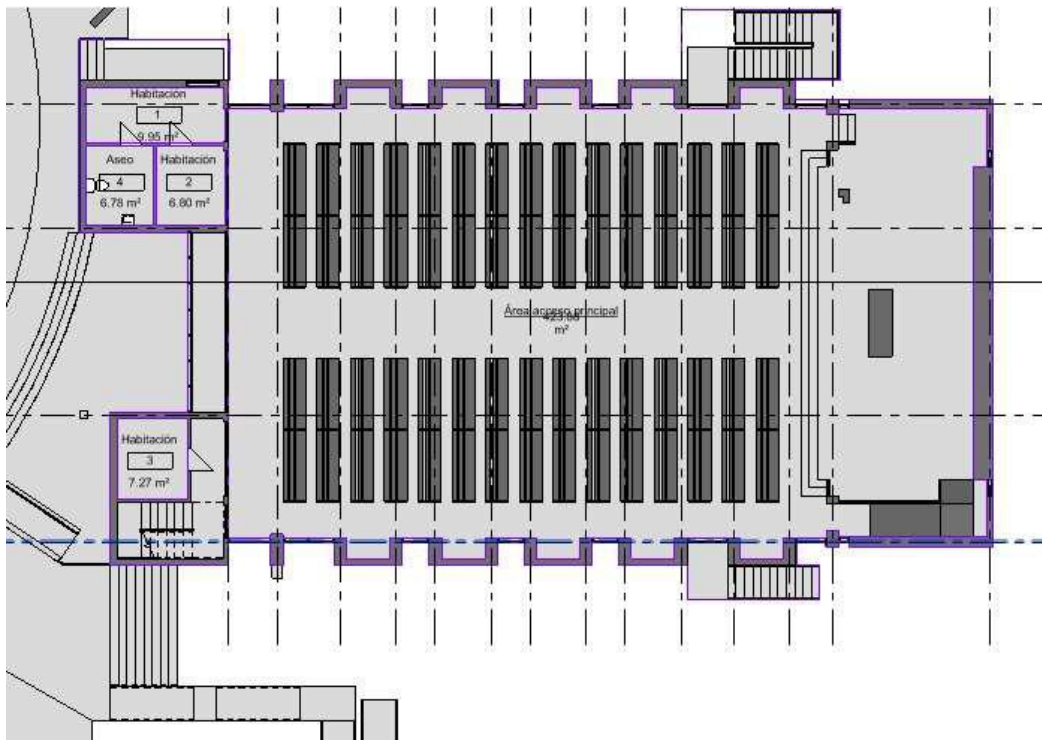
Imagen Revit distribución de espacios en planta nivel ACCESO
